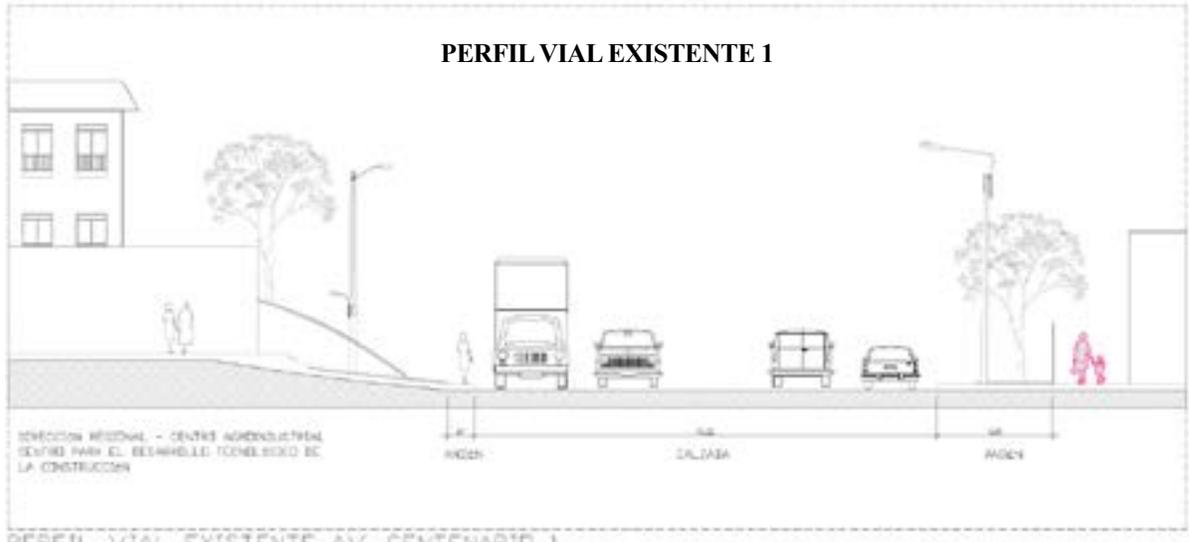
e Ilustración 16. Perfil vial Av. Centenario. Fuente: Dimensiones tomadas de los perfiles viales elaborados por el equipo arquitectónico.
